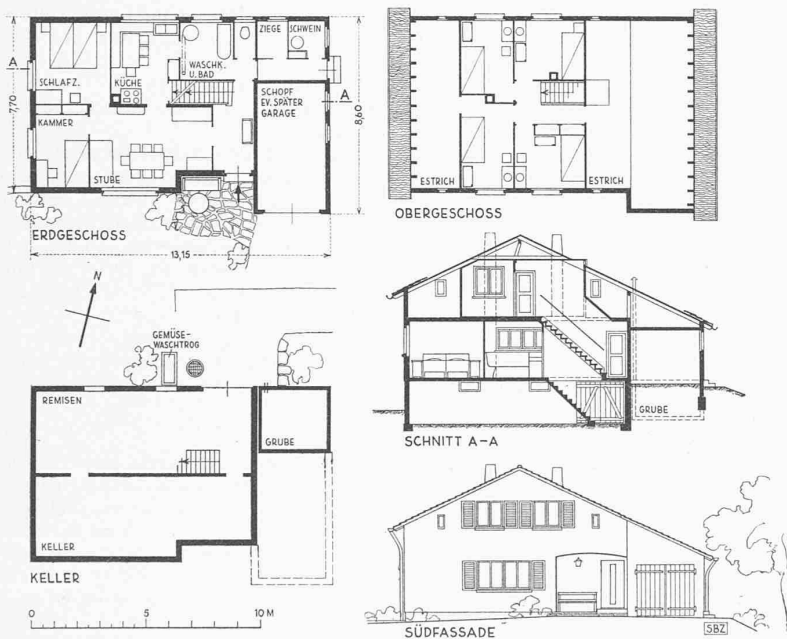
Grundrisse und Schnitte 1 : 300 der Gartenbausiedlung E. E. in Zollikoberg
